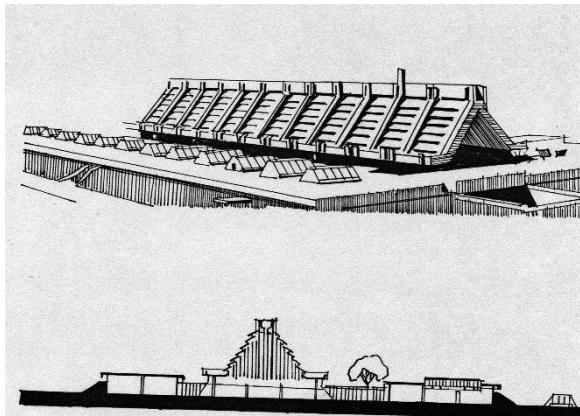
17. Сборочный корпус автомобильного завода Вольво в Кальмаре, Швеция
